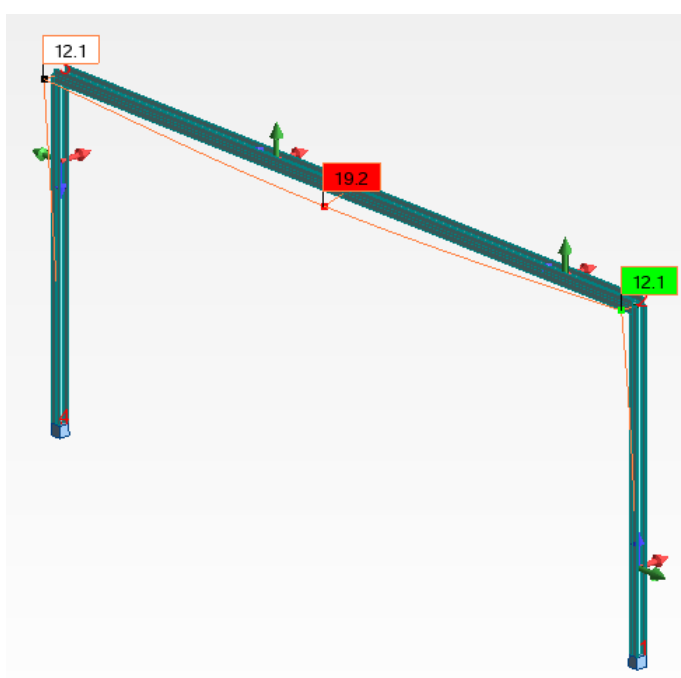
Deformações N1 alternativa pilares HEB 220 viga HEB 280
